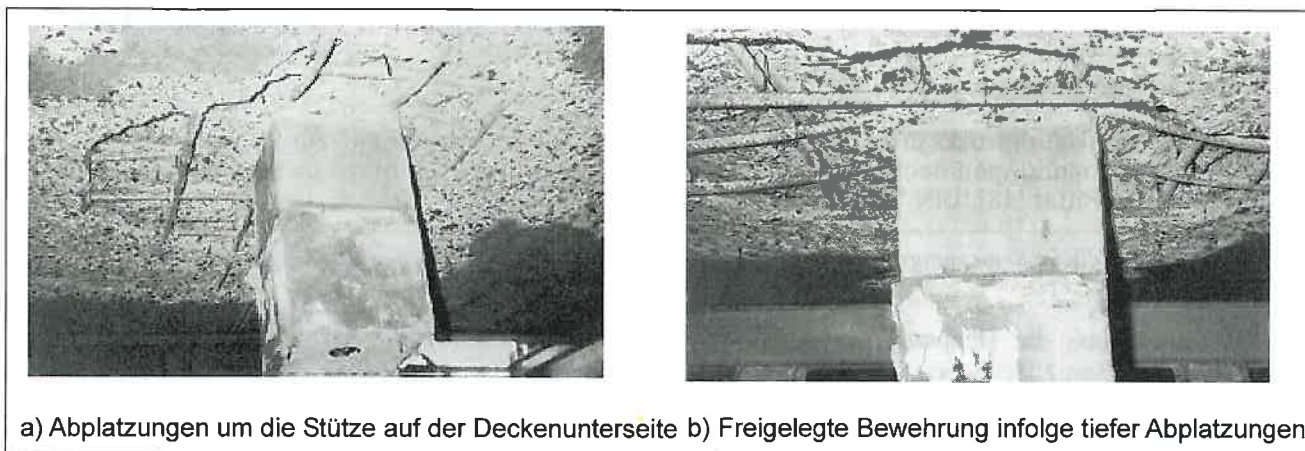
Deckenuntersicht mit Abplatzungen bei Durchstanzversuchen im Brandfall (nach [14])
